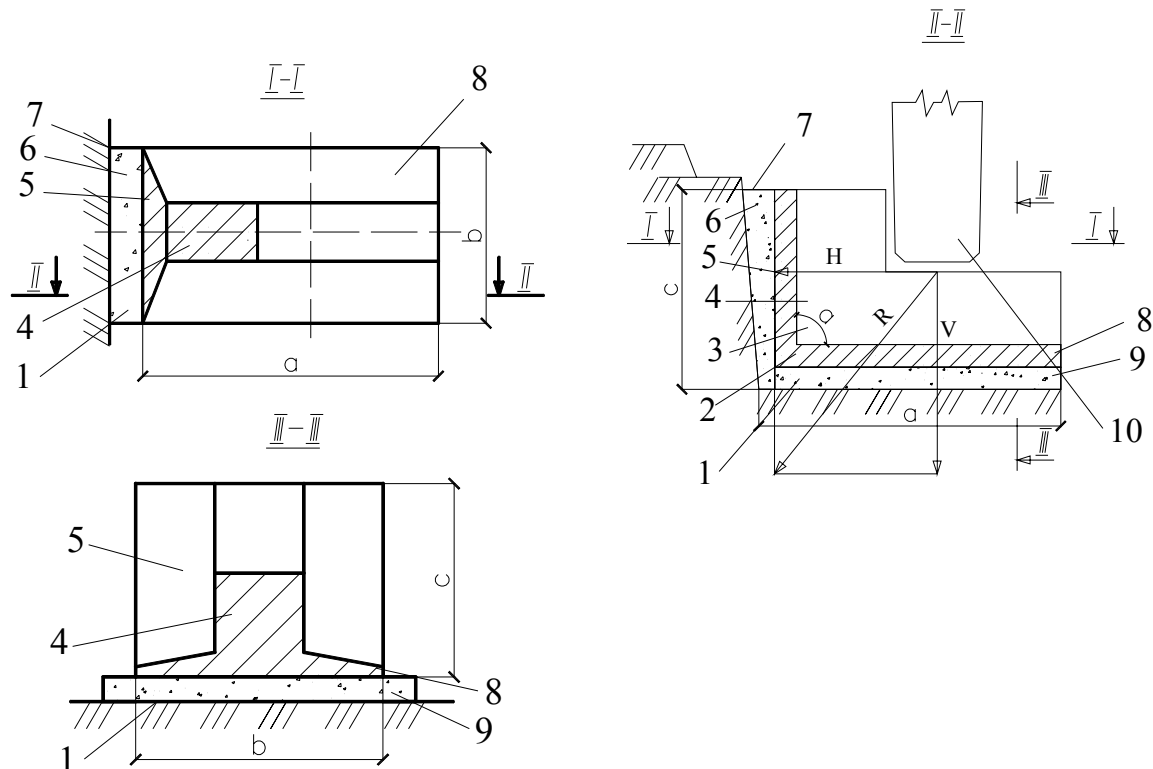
Кутниковий фундамент: 1–несучий шар ґрунту; 2–кутниковий фундамент; 3–кут $90\text{--}120^\circ$; 4–поперечне ребро; 5– лобова стінка; 6– шар бетону ущільненого щебеню, піску; 7–поверхня ґрунту, непорушеної або втрамбованої структури; 8–подушка; 9– підготовка; 10–п'ята стійки рами
